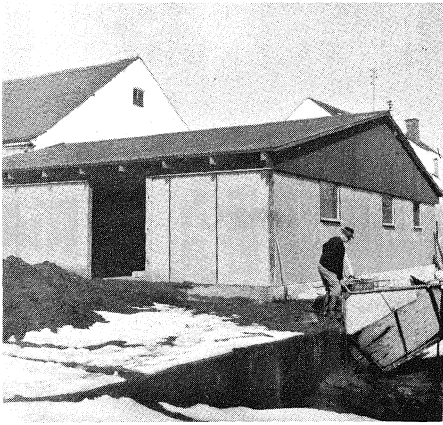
Versuchsstall aus tragenden Kunststoffelementen. Die Dachkonstruktion (Gang-nail-Binder mit Bitumenwellplatteneindeckung und Kunststoffzwischendecke) wird direkt von den Wandelementen getragen
